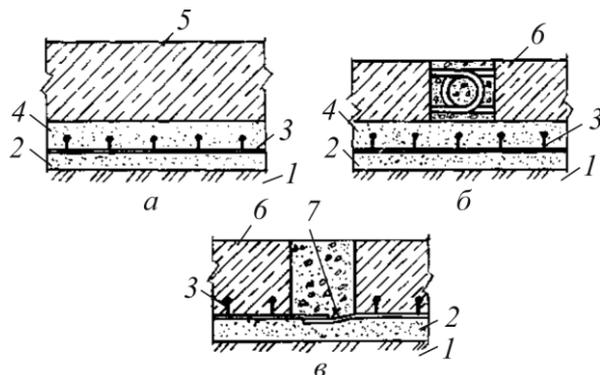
Узлы гидроизоляции из полимерного листа:
